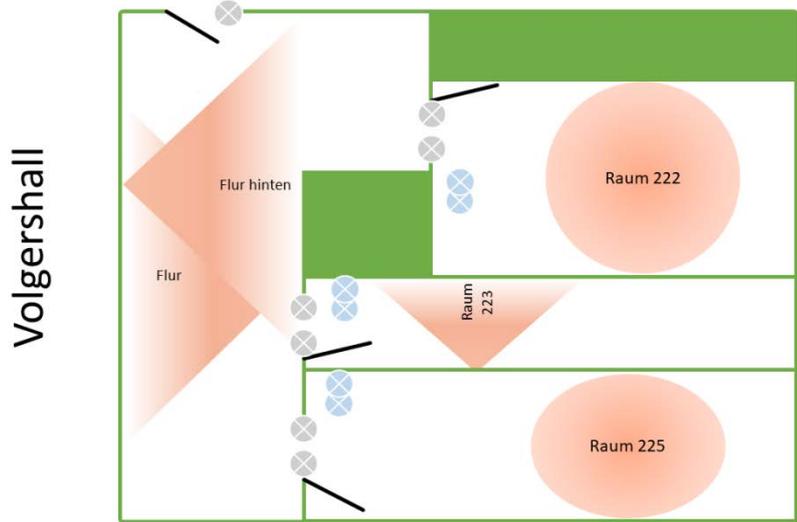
Grundriss der Räumlichkeiten mit Sensoren.
